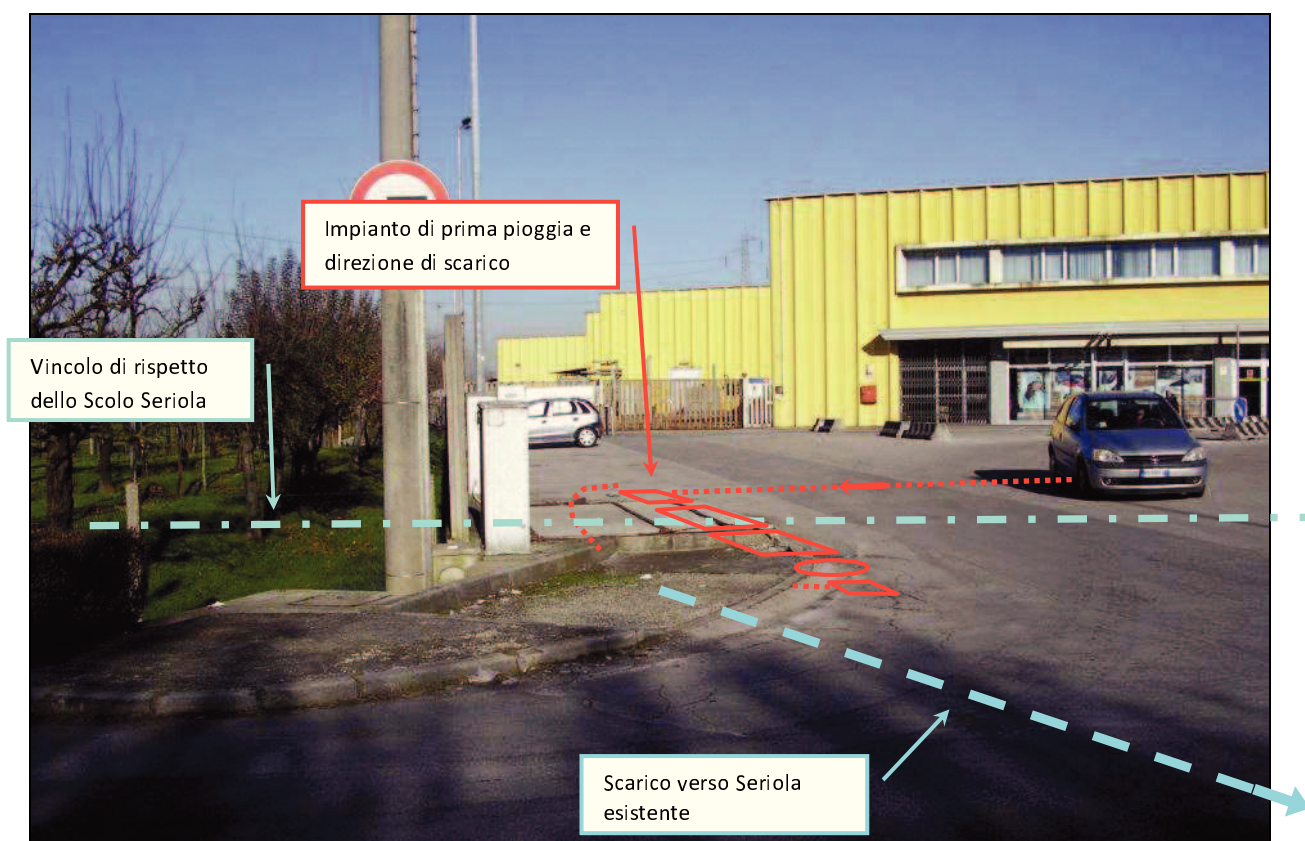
Prospetto sud - da via Bastie verso nord: vista del sedime di installazione dell'impianto di prima pioggia
